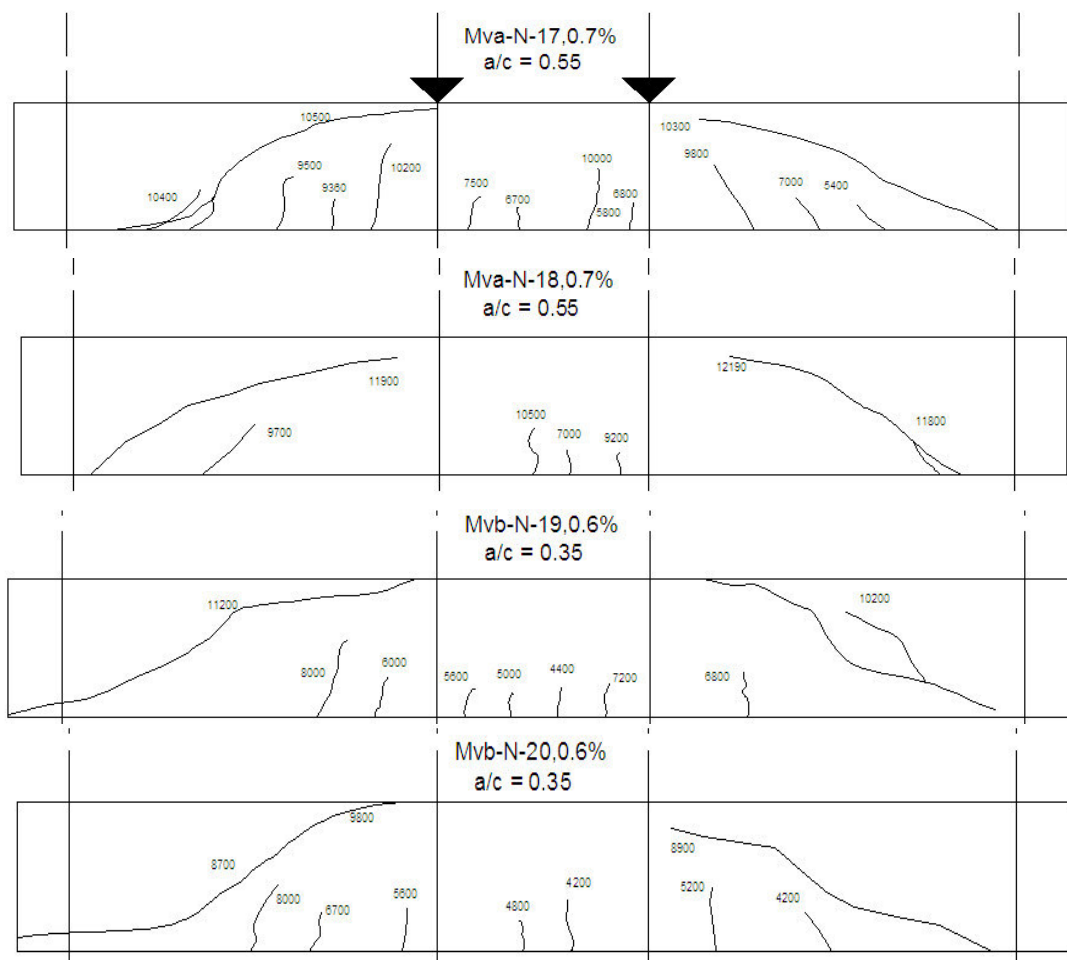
Patrón de agrietamiento para las vigas reforzadas con fibra de acero en el alma, para las dos relaciones (a/c).
